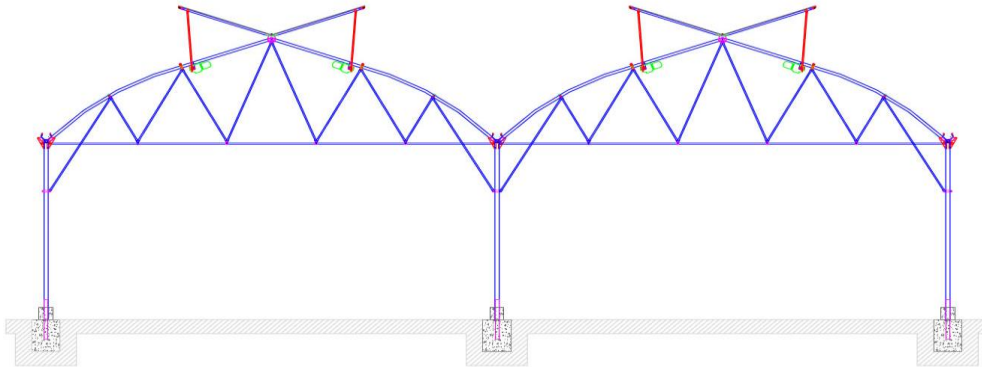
Çevre Temel ve Yan Perde Beton
